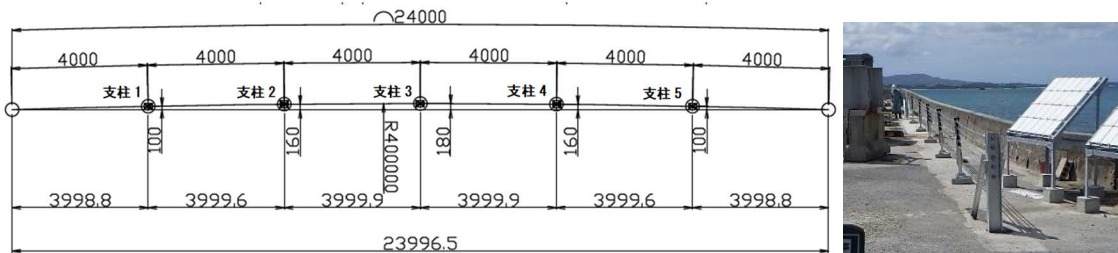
暴露供試体平面図 (単位：mm) と暴露供試体支柱設置状況
